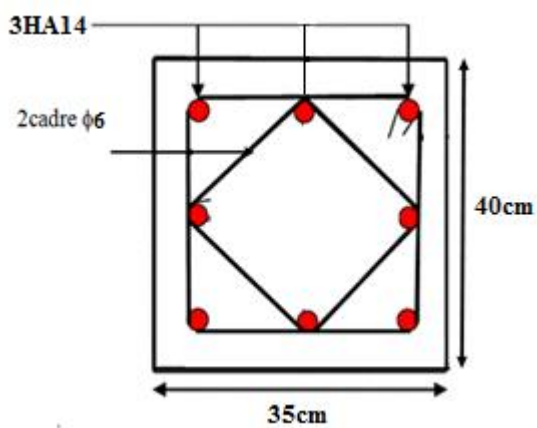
Schéma de ferrailage des poteaux 7^{ème} et 8^{ème} étage.
